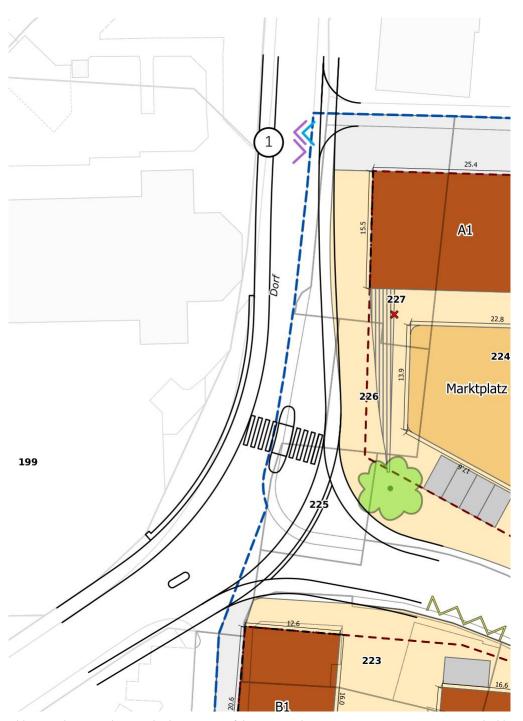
Bebauungsplan mit überlagertem Ausführungsprojekt Kantonsstrasse vom 20. Sept. 2018 (Felder+Partner, Entlebuch)
